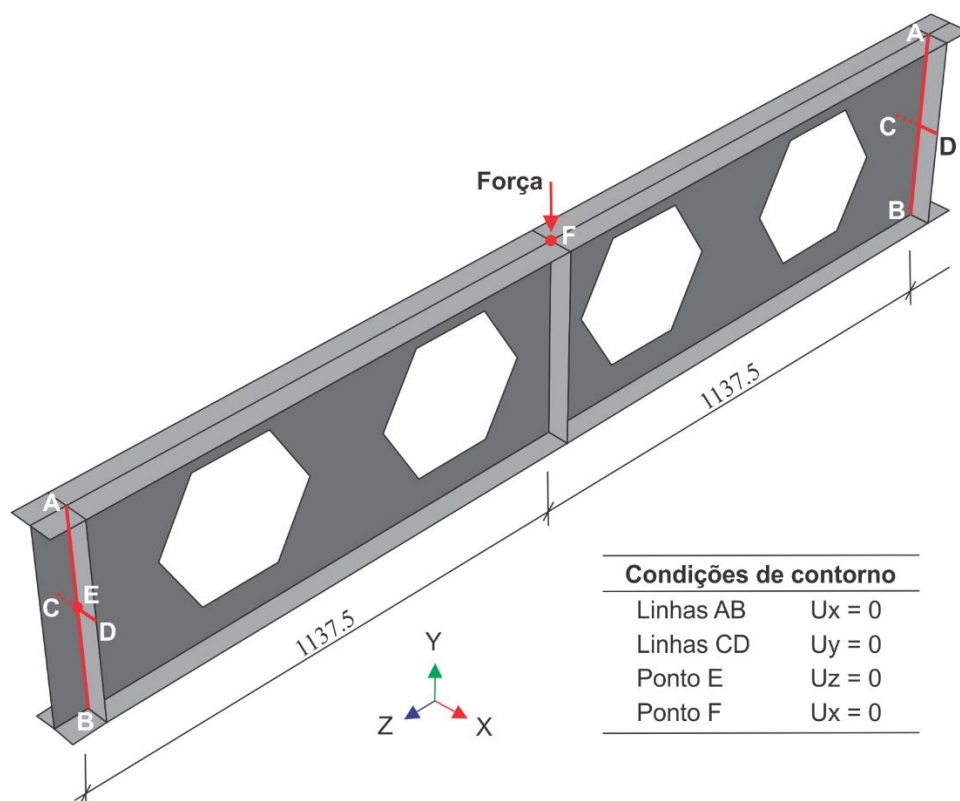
Geometria das vigas D, E, F, G e H ensaiadas por Toprac e Cooke (1959).
